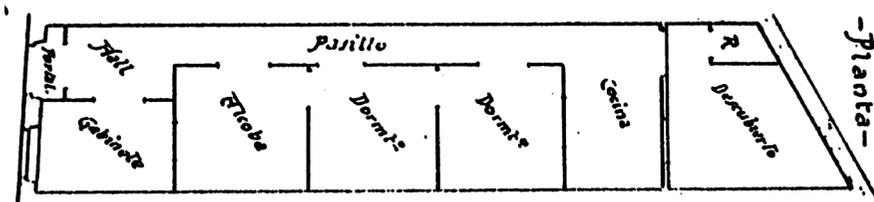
| Enrique López Rull. Avenida de Vilches.
